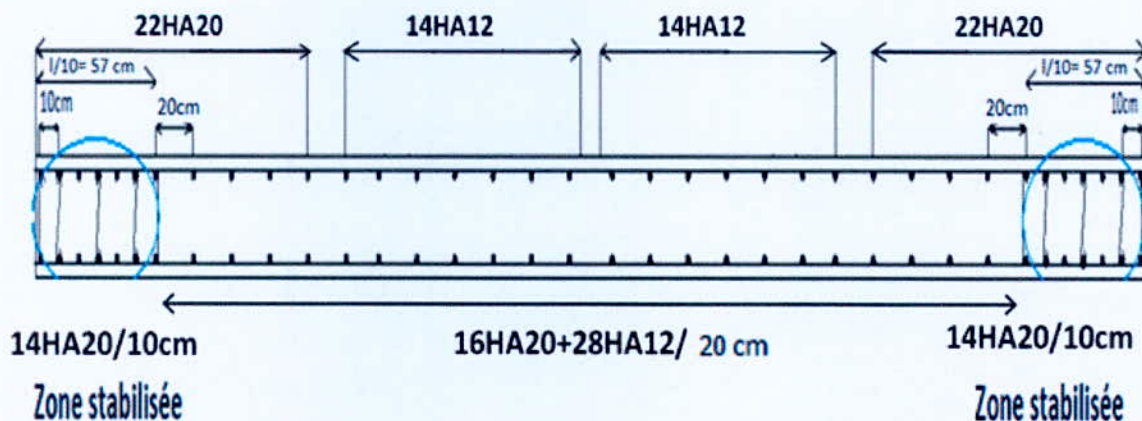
Disposition du ferrailage dans la rotule plastique.
